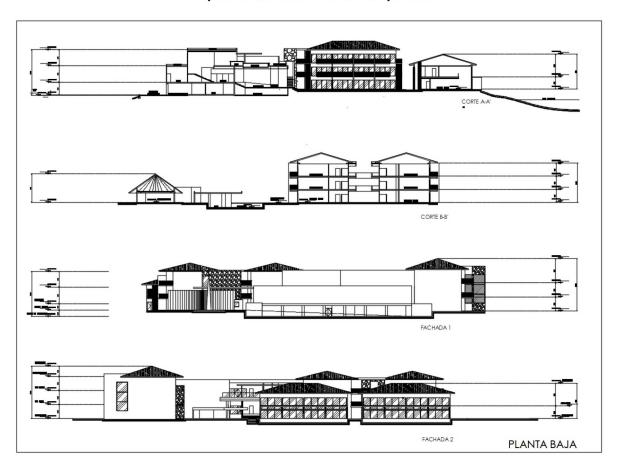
Plano arquitectónico de cortes y fachadas del proyecto.
